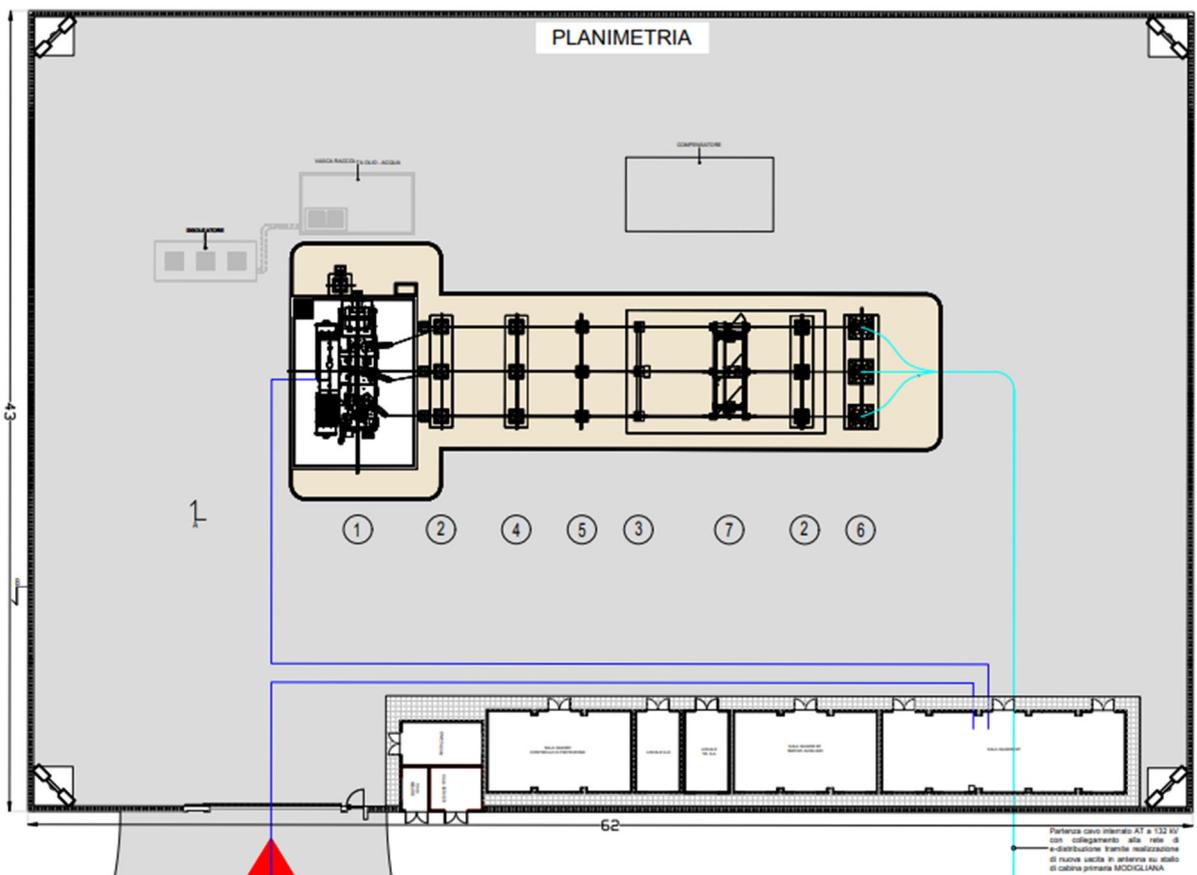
Planimetria della SSE utente di trasformazione e connessione da SMG_T_07_A_C_A_1
